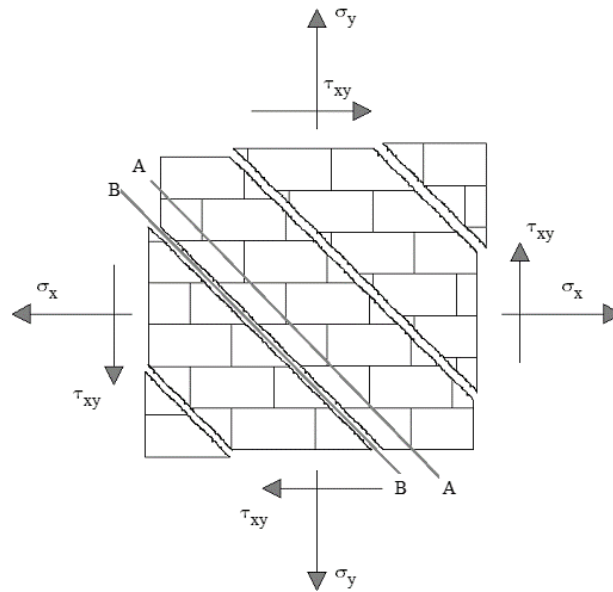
Estado de esfuerzos del macroelemento agrietado de mampostería
